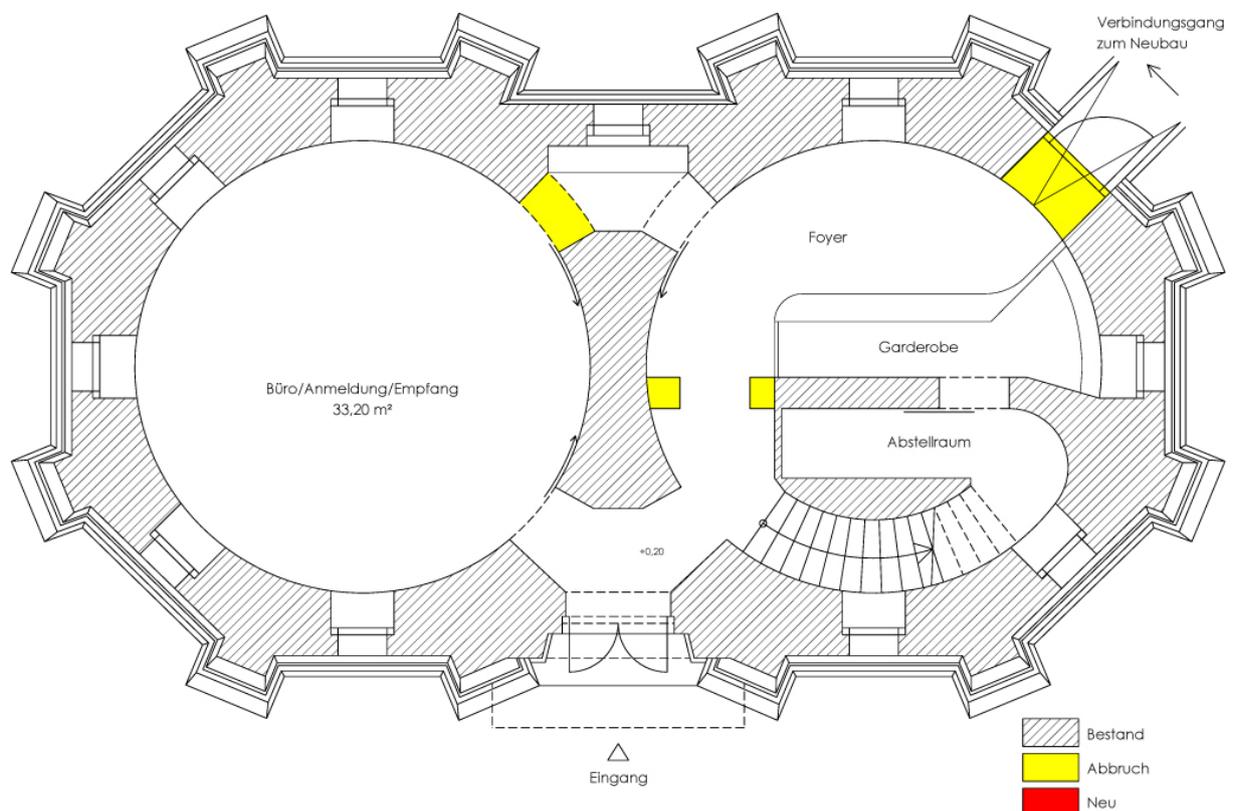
Grundriss Erdgeschoß Wasserturm - Veränderungen
